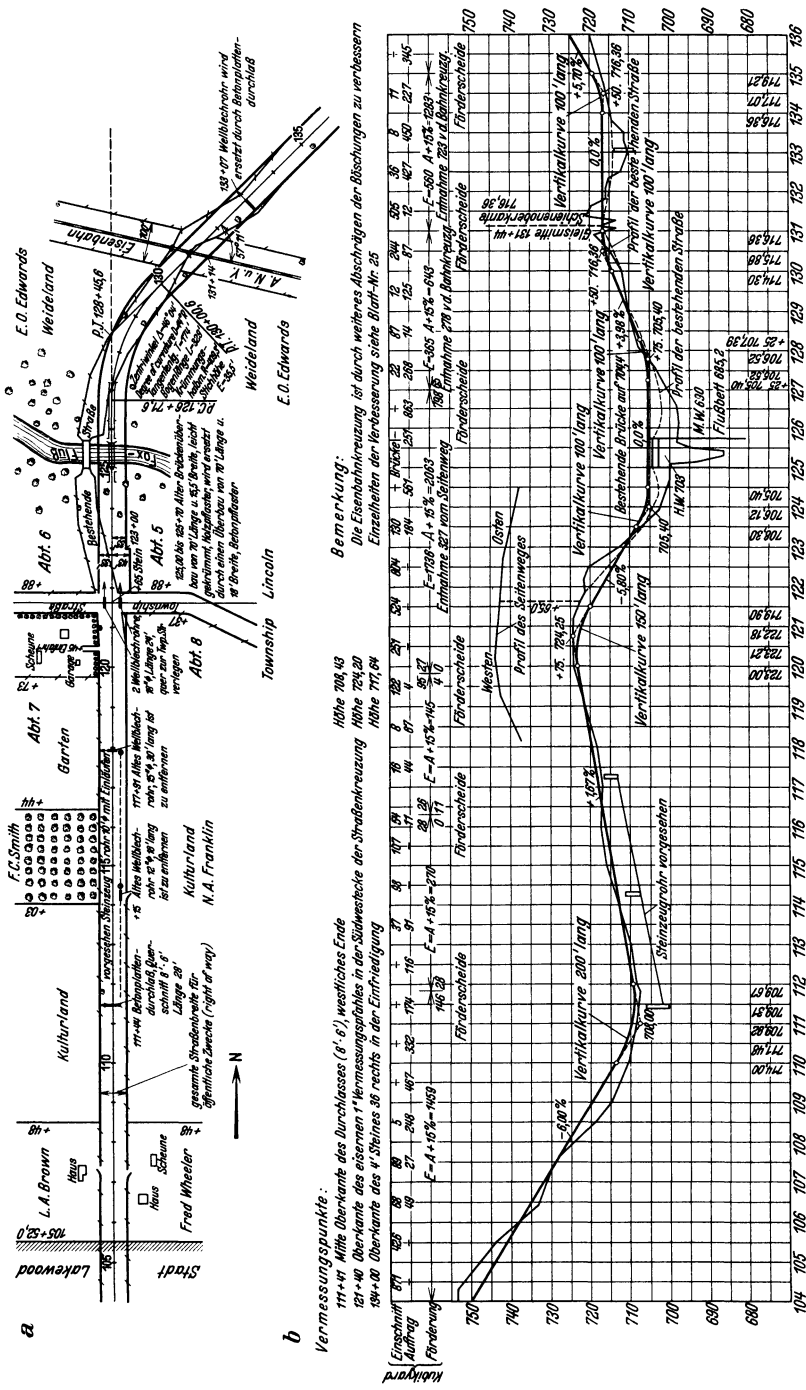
Amerikanische Straßenplanung, a) Lageplan, b) Höhenplan [A 1].
